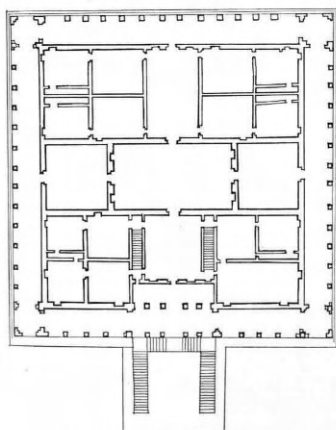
Planta Baixa - Villa Poggio a Caiano - Fonte: Heydenreich, 1998.
